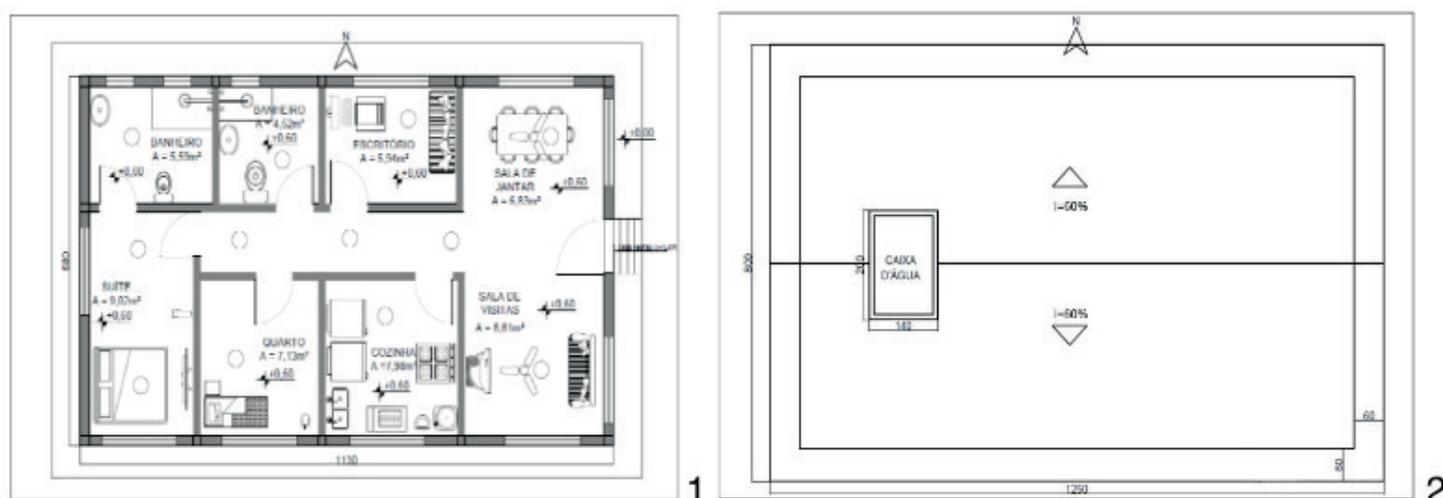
Planta baixa da edificação. Figura 2 - Planta de cobertura da edificação.
